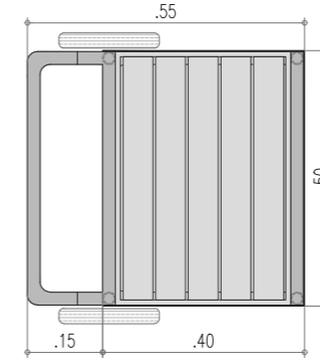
Planta puesto de venta ambulante tipo 1. Esc 1:15
